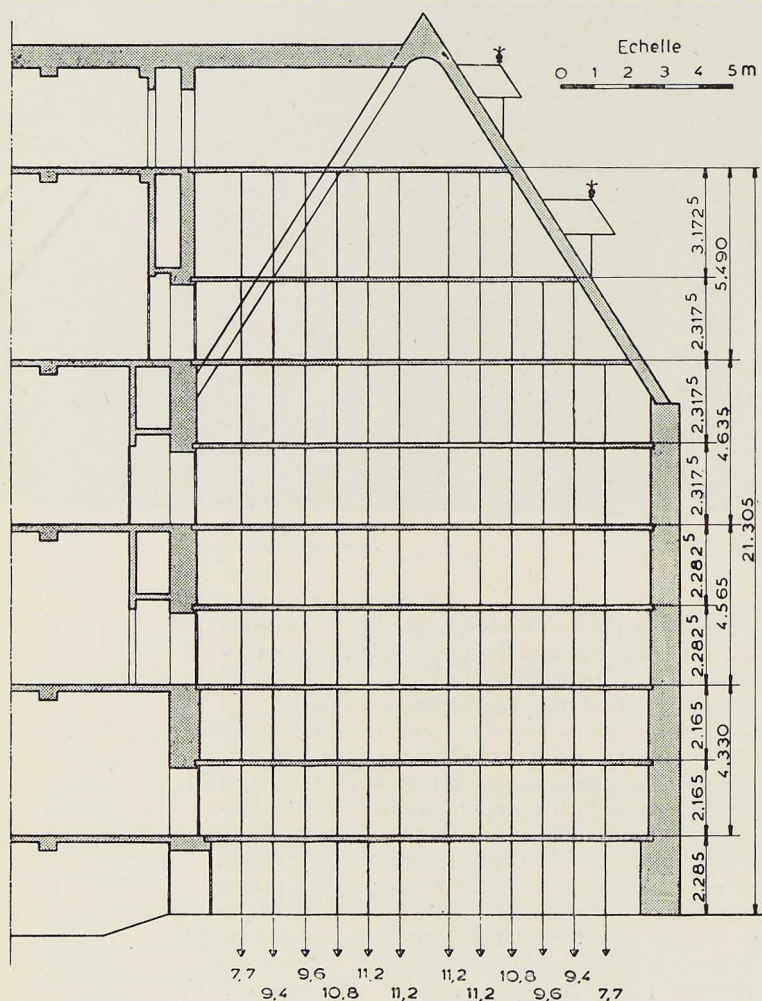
Coupe A-B (voir plan, fig. 2, p. 375).
